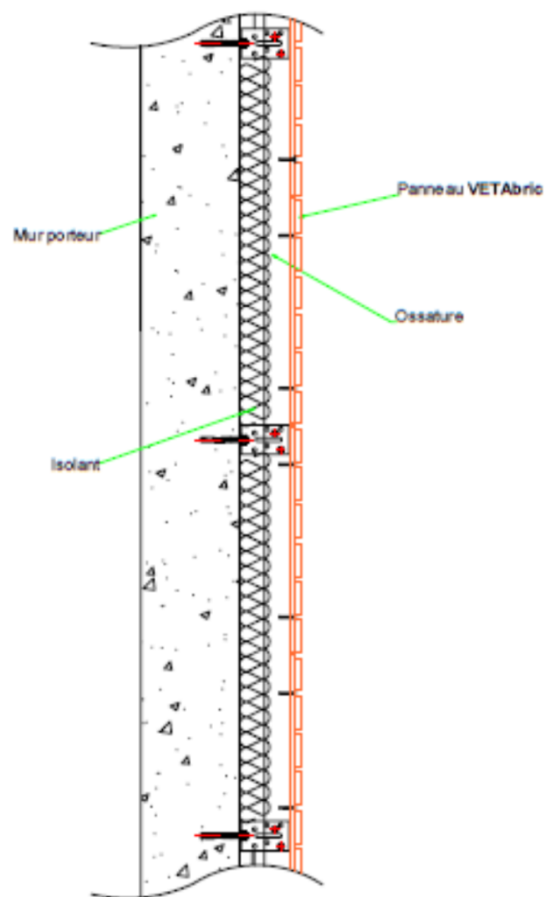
Principe de pose VETabric sur ossature métallique, coupe verticale
